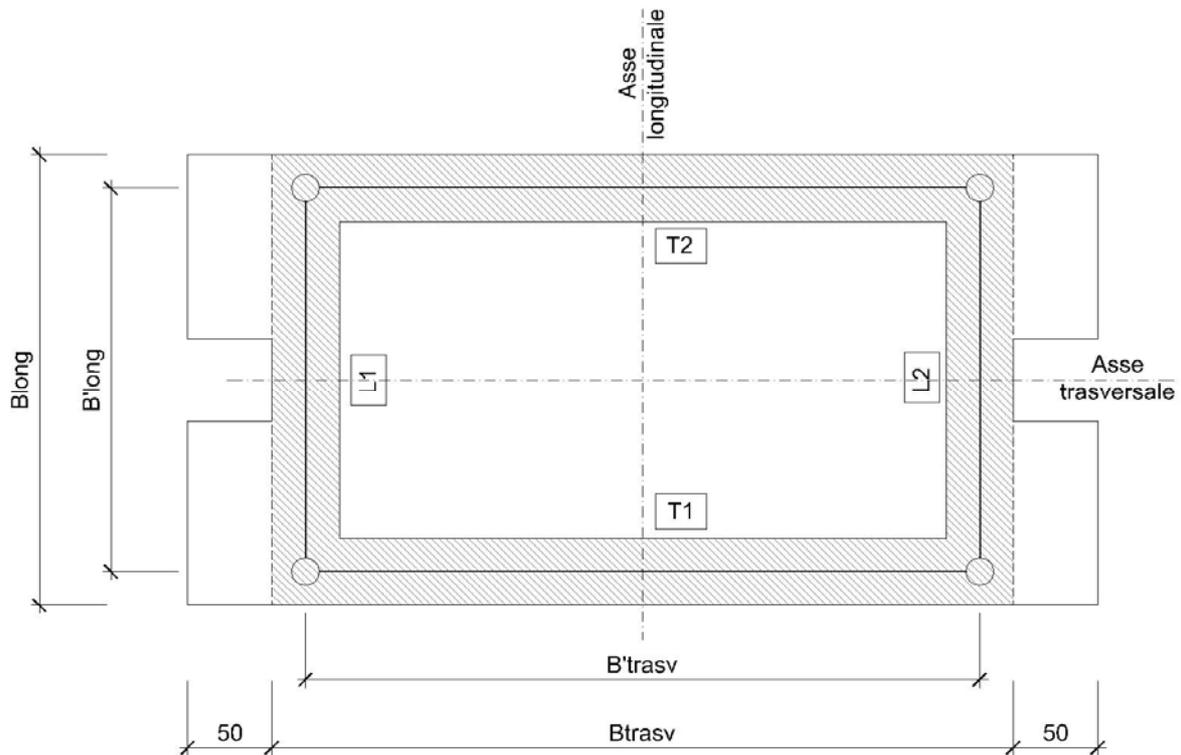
Sezione di calcolo e convenzione codifica singoli pannelli
